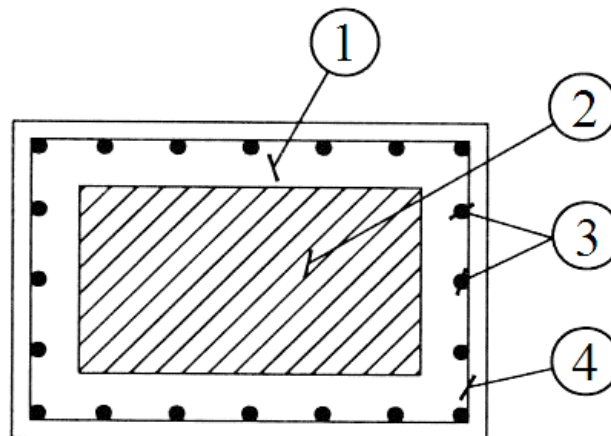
Querschnittsergänzung einer rechteckigen Stütze: (1) Querschnittsergänzung (Beton), (2) bestehender Betonquerschnitt, (3) neue Längsbewehrung, (4) neue Bügelbewehrung<sup>110</sup>
